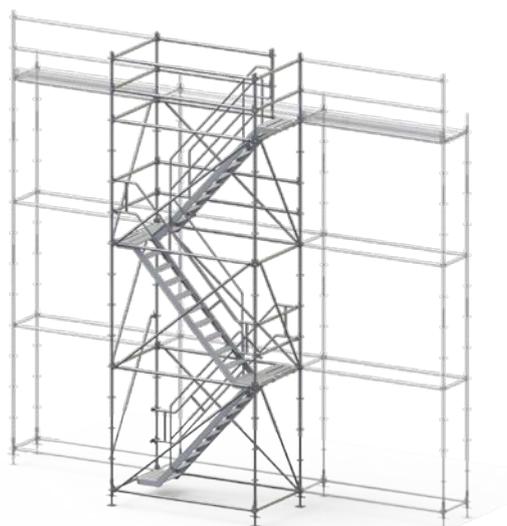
Torre de escaleras de plataforma 2,57x1,40x2,0m. Escaleras opuestas y salida lateral sin barandillas exteriores.
